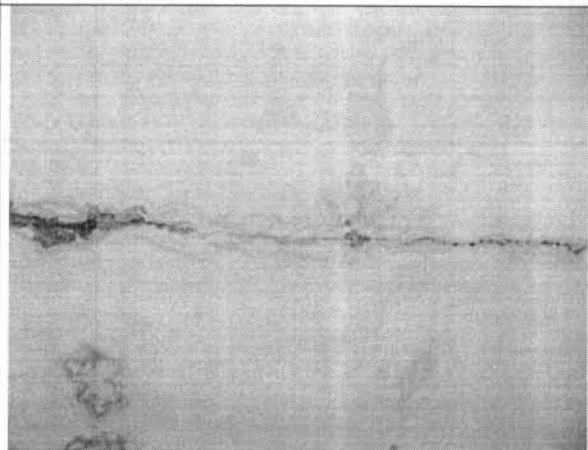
Detalle de la marca de filtraciones de agua en la cubierta del mezanine.
